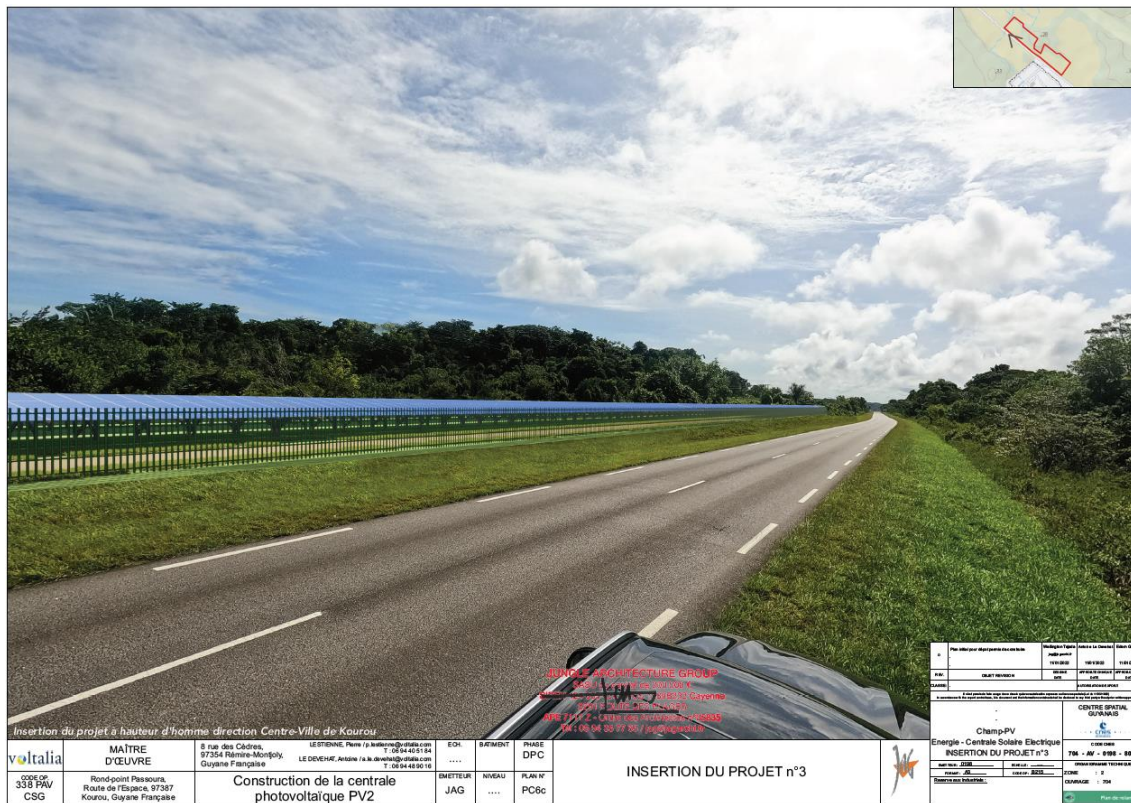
Photomontage de l'insertion du projet à hauteur d'homme direction centre-ville de Kourou (source : Permis de construire 12/2022)
